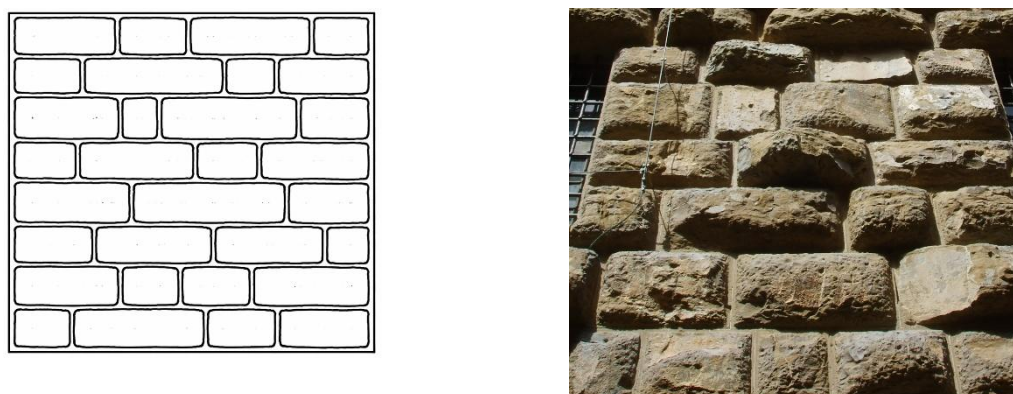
Alvenaria aparelhada (Botelho, 2023)
